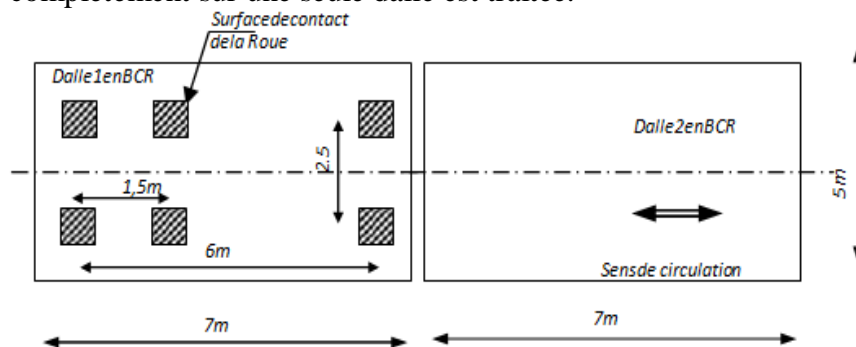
Trois essieux sur une dalle - vue en plan] (Espacement 1,5m et 6m entre essieux, dalles 7m × 5m)
